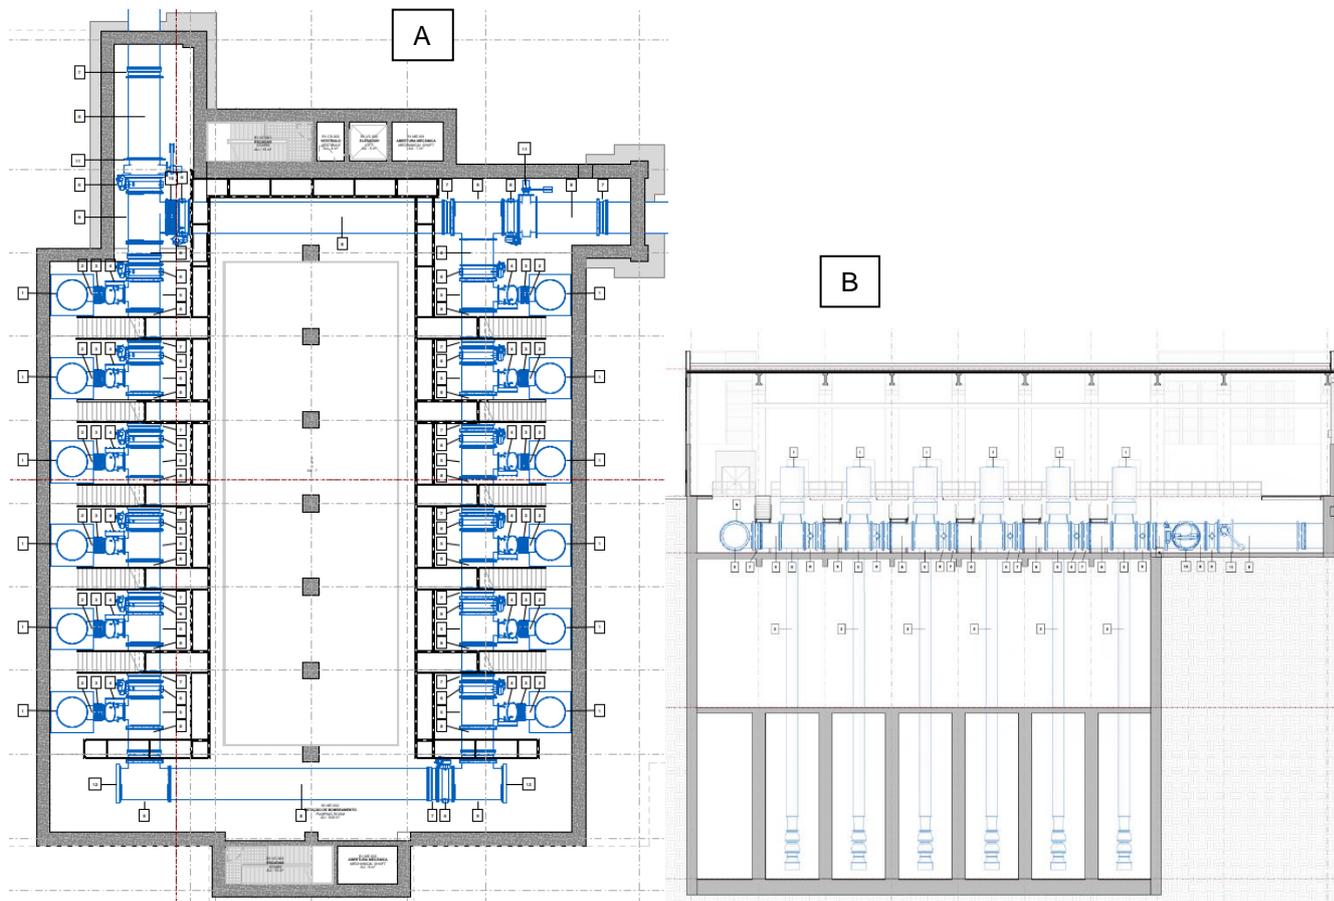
(a) Planta e (B) Seção Longitudinal da Estação Elevatória.
